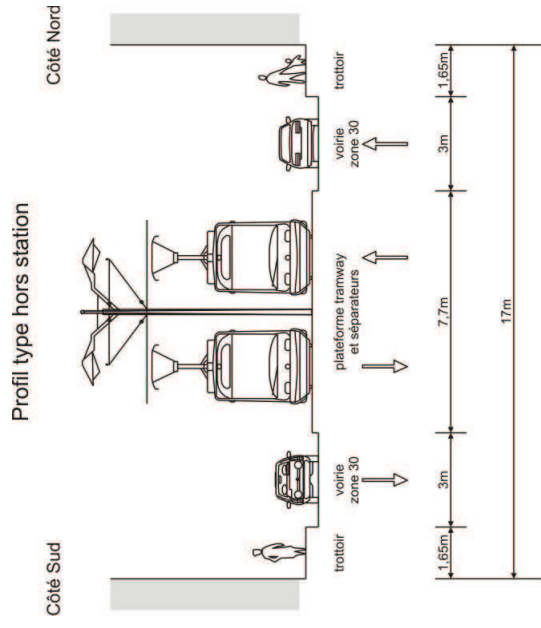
Profil type hors station : dimensionnement "a minima" admissible sur la rue de *Géroldseck* ou sur la route des *Romains
